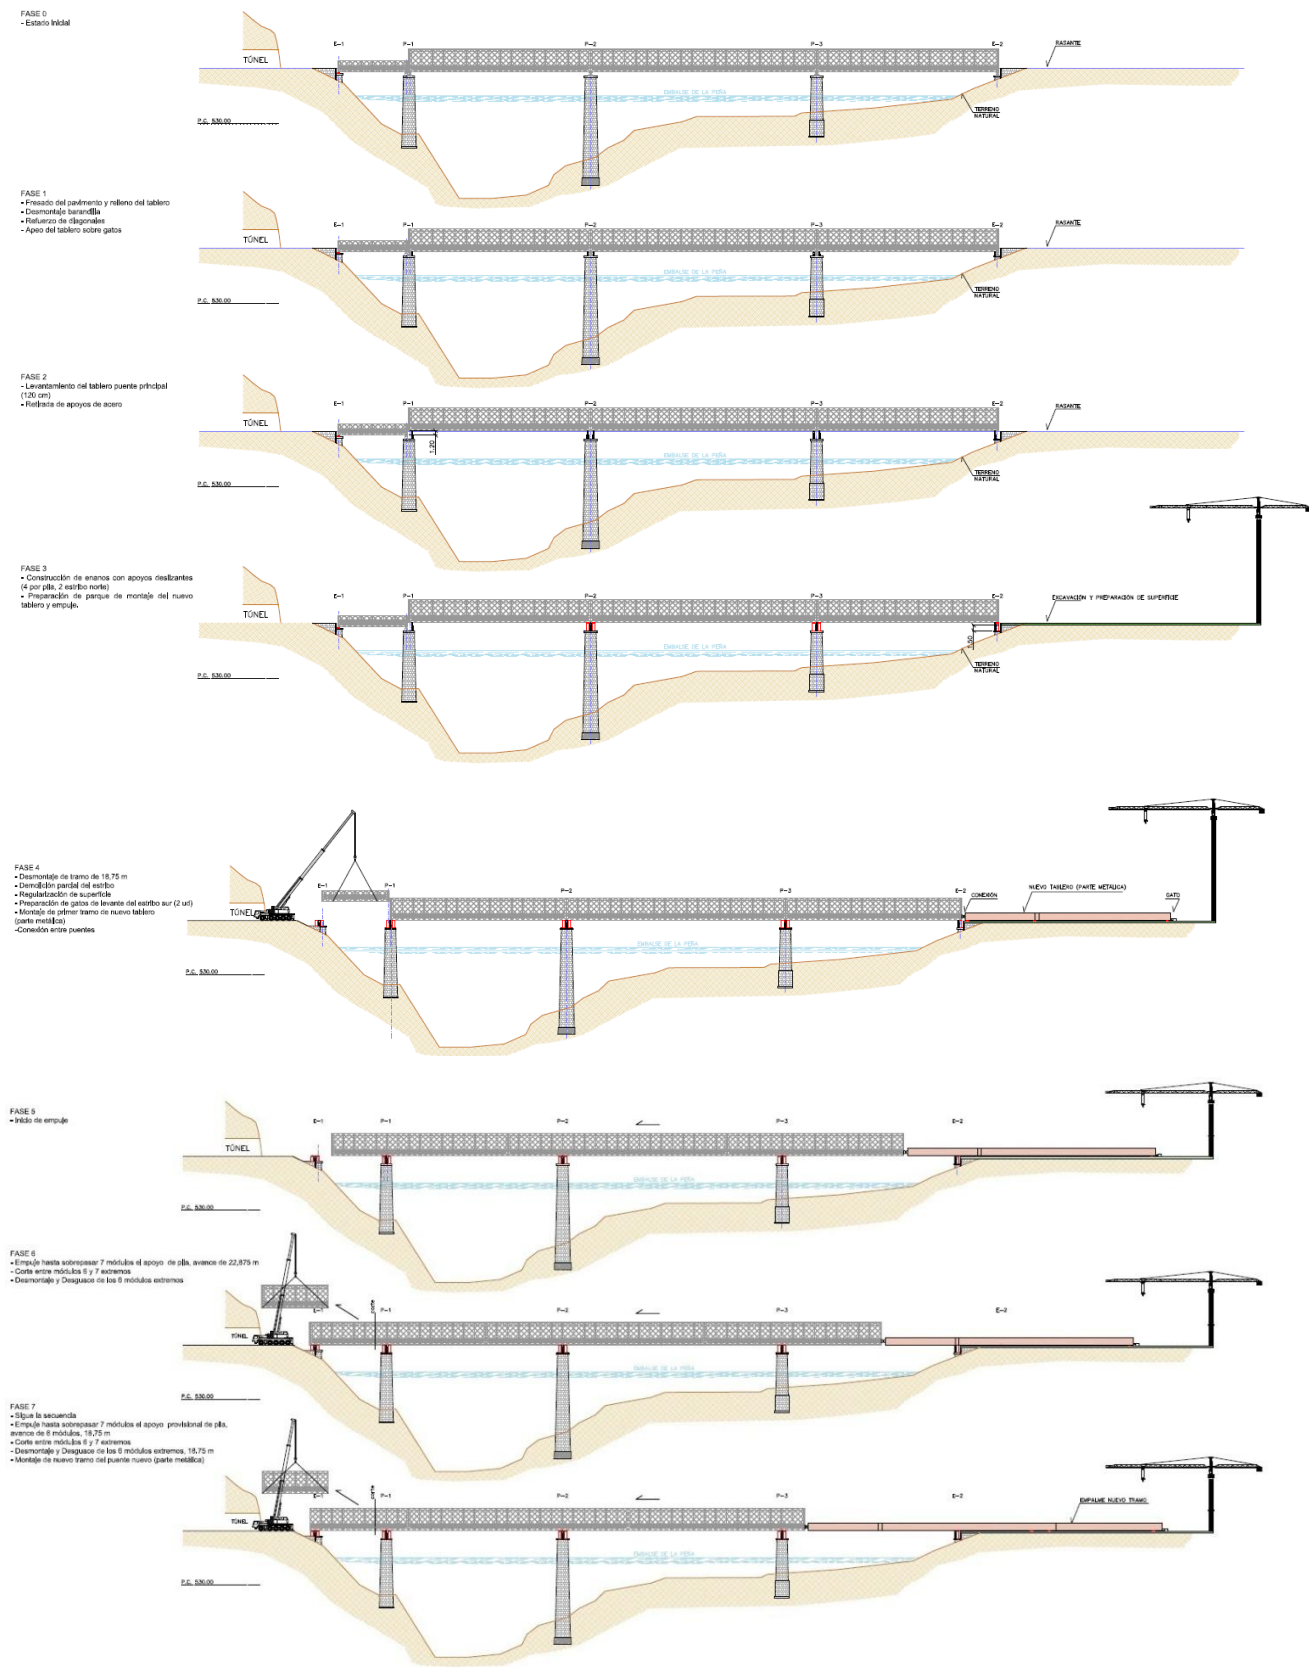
Procedimiento constructivo para la sección tipo - mixta
